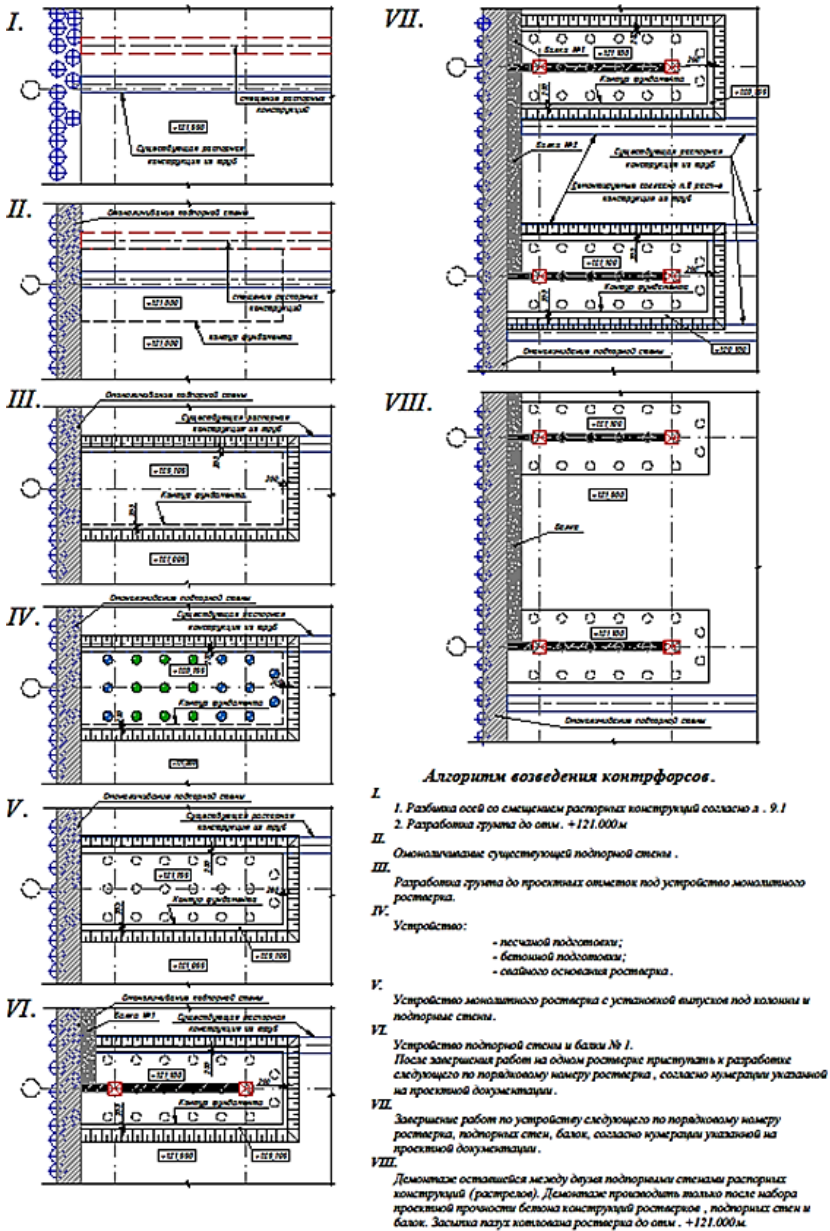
Разработанный алгоритм создания монолитных железобетонных контрфорсов
